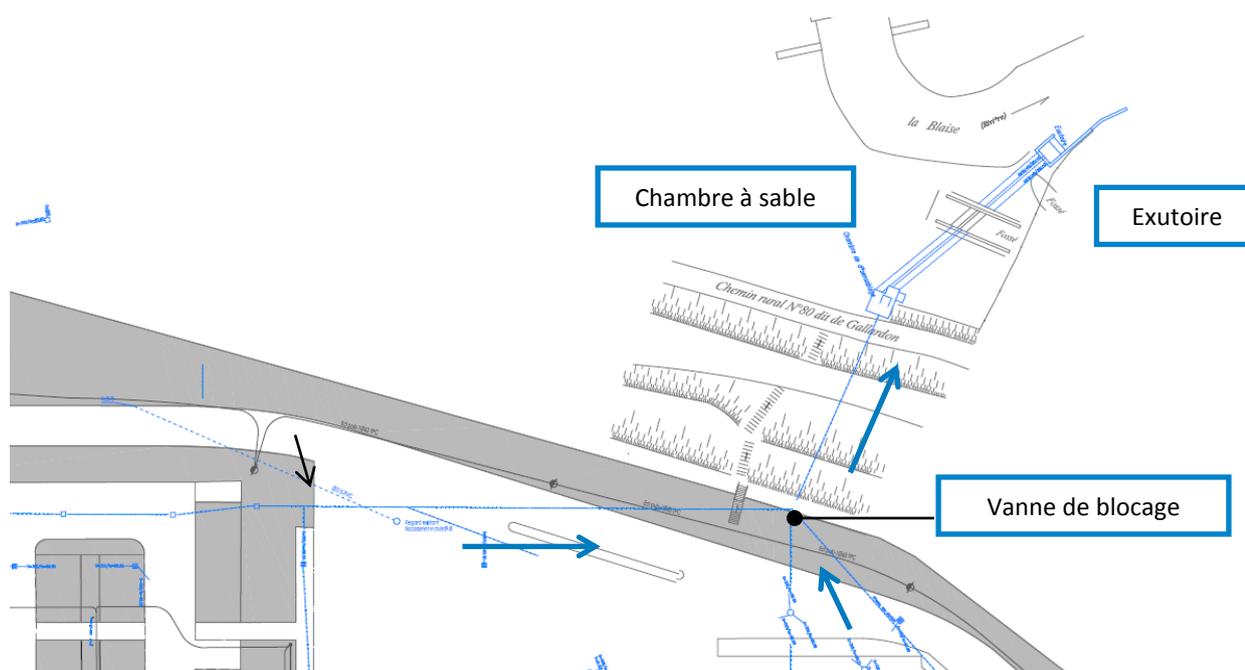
Plan de localisation des exutoires d'eaux pluviales
